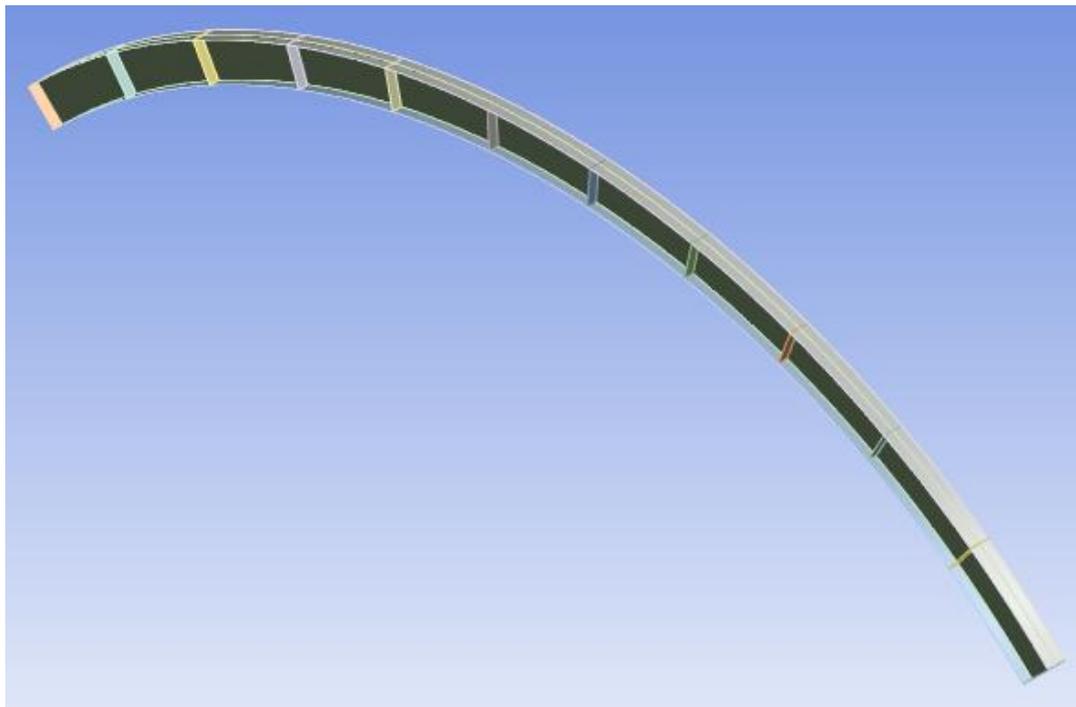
Arco circular de sección 'I' con alma plana y 12 rigidizadores transversales.
